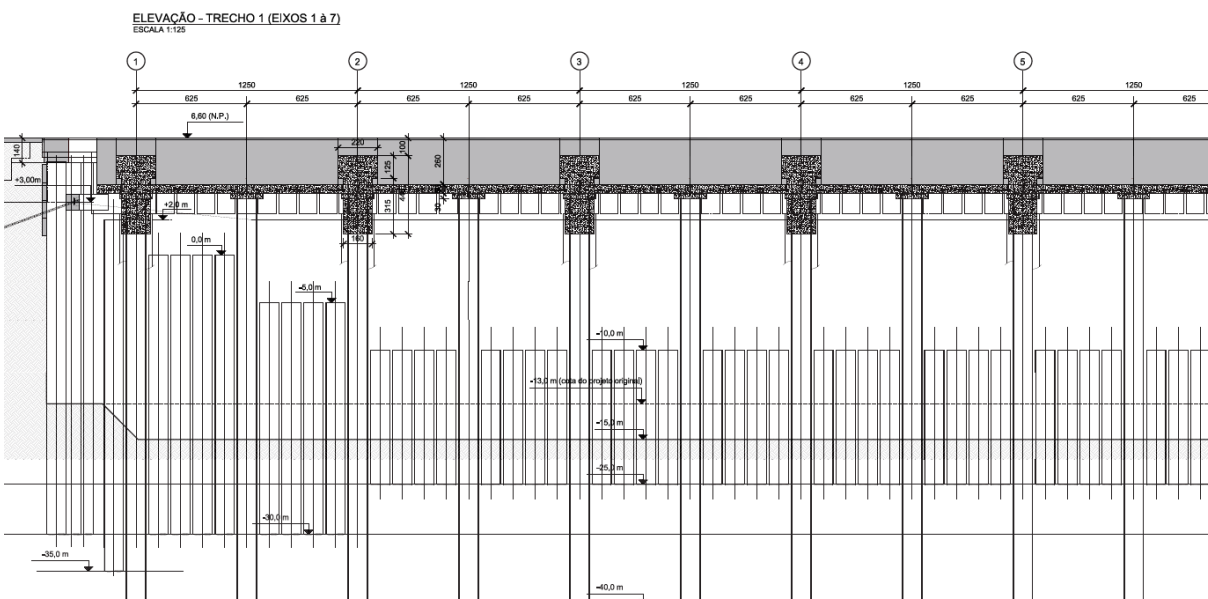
Elevação frontal - formas da superestrutura com reforços propostos.
